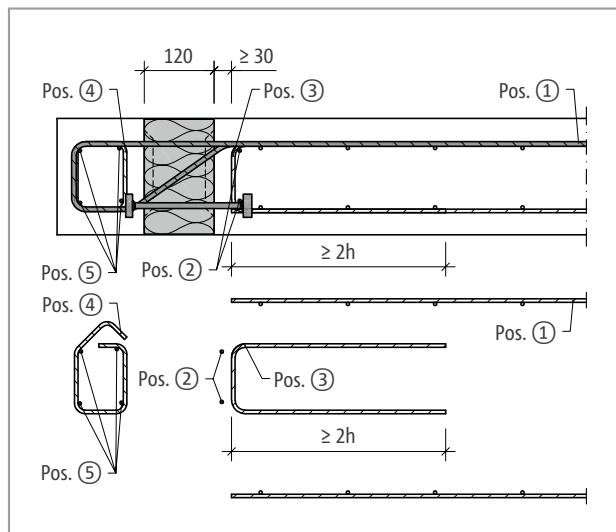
Schöck Isokorb® XT Typ O: Bauseitige Bewehrung
